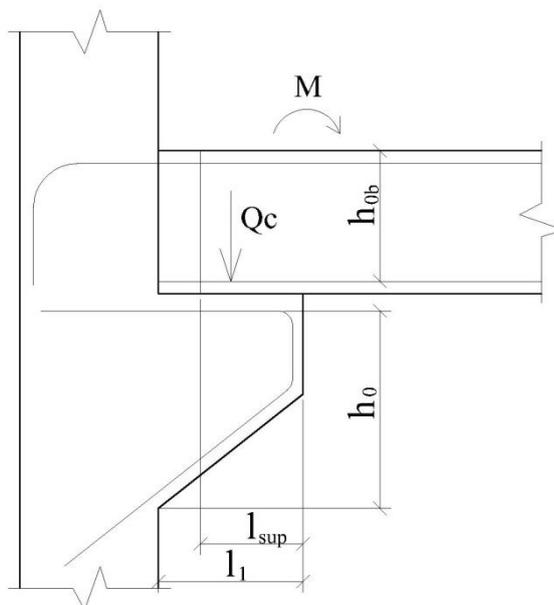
Расчетная схема для короткой консоли при рамном узле сопряжения колонны и сборного ригеля
